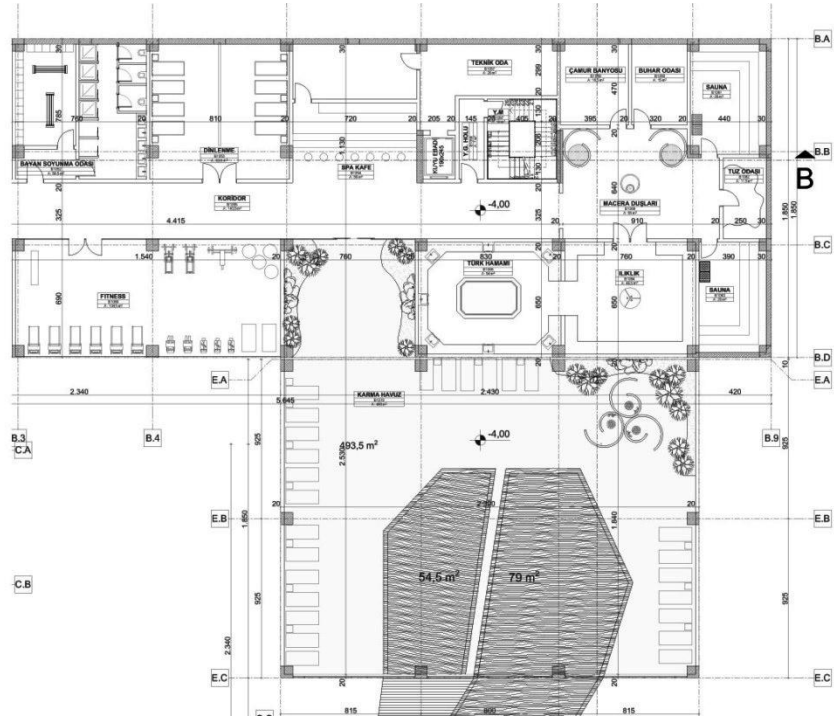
Mercan Hotel Giriş Kat Planı.⁹⁸
